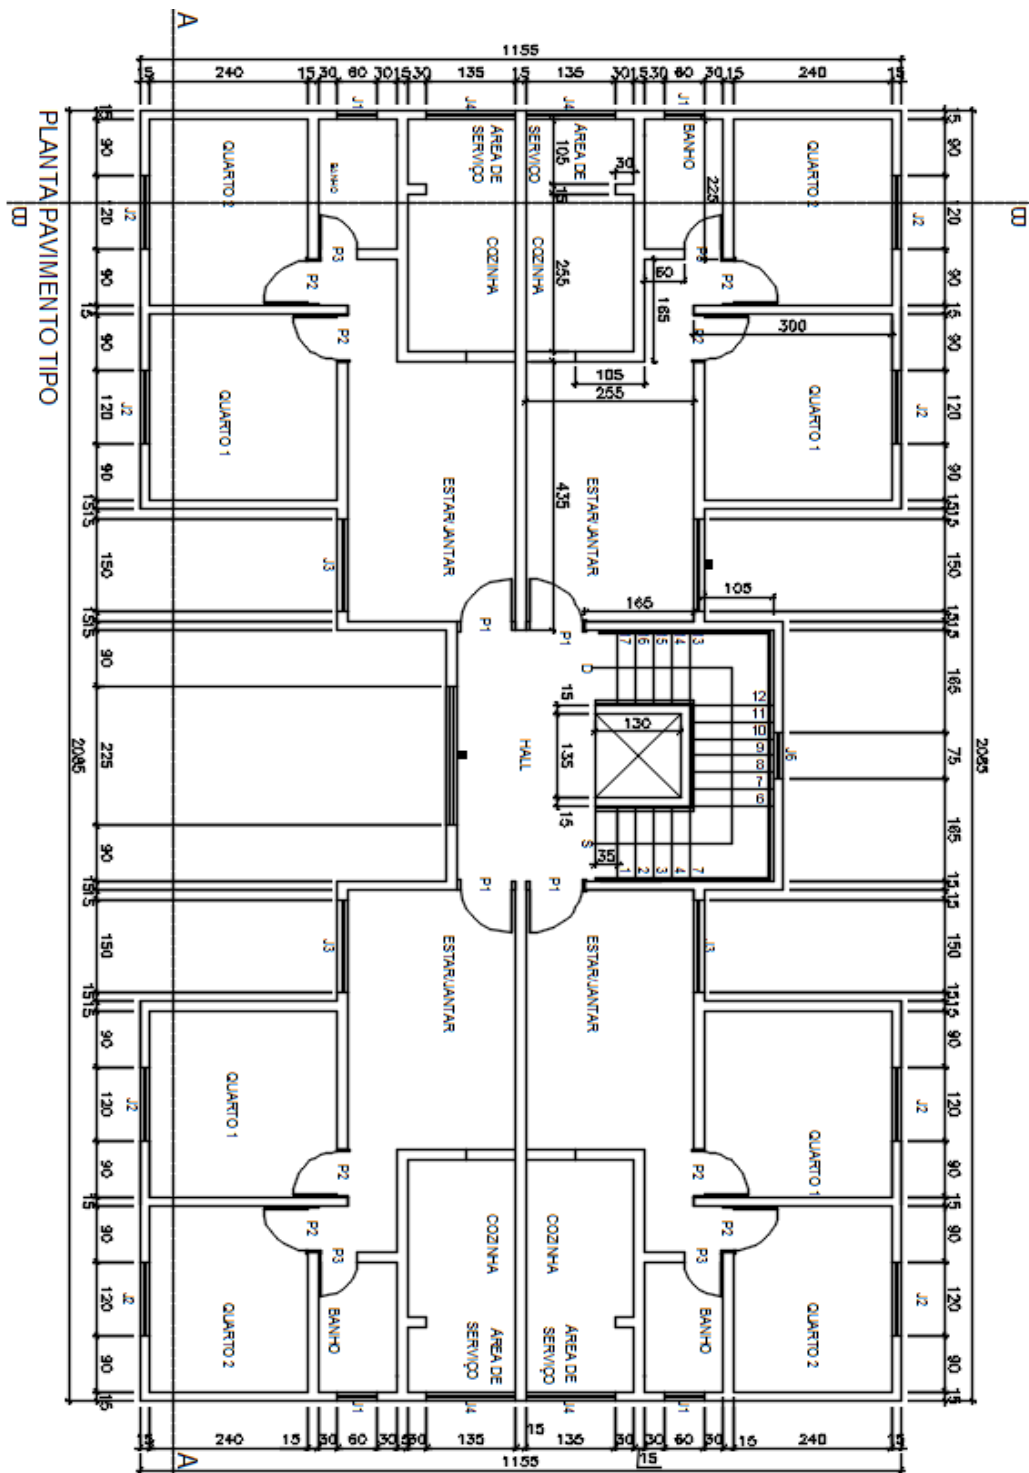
Planta arquitetônica do pavimento tipo. – Cedido por prof. Dr. Roberto Márcio
